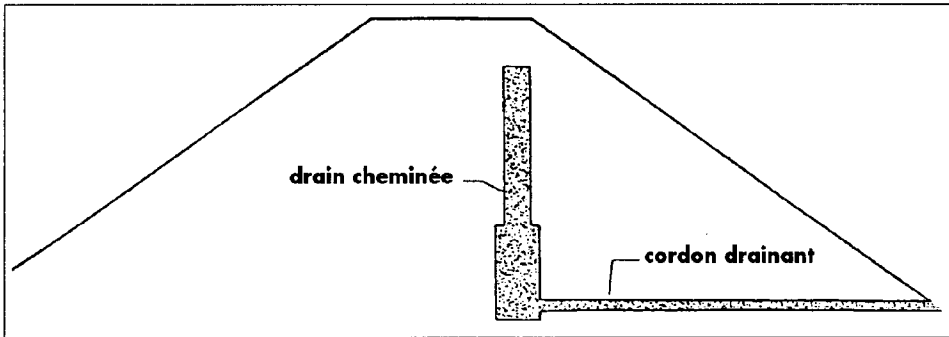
Dispositif drainant d'un remblai argileux homogène
